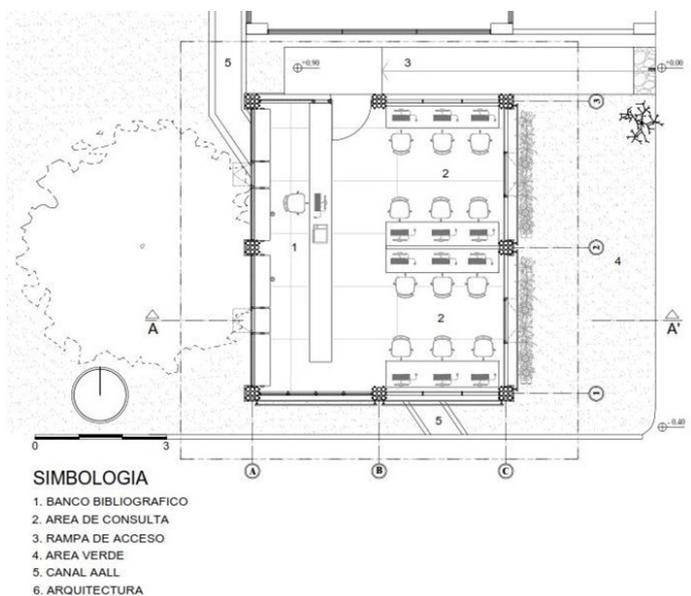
Planta arquitectónica del Centro de Documentación del Bambú [5]
